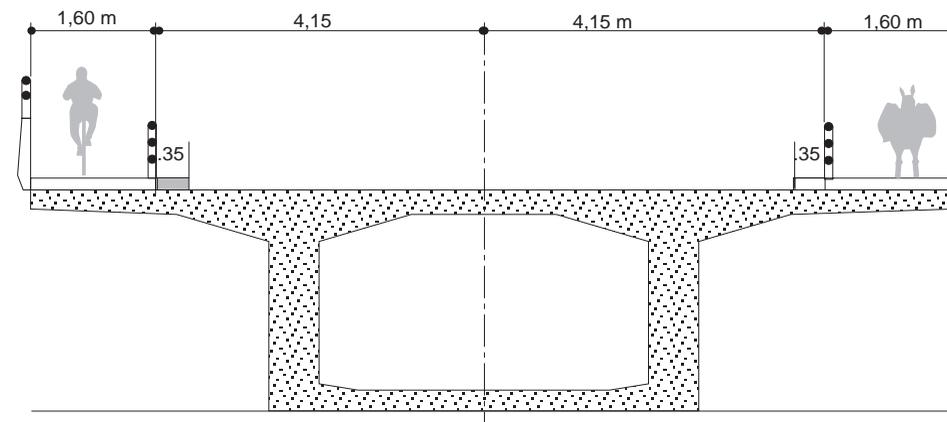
Sección propuesta del puente cuadrada de 30 cm de lado, con el plano vertical de frente al acceso.
